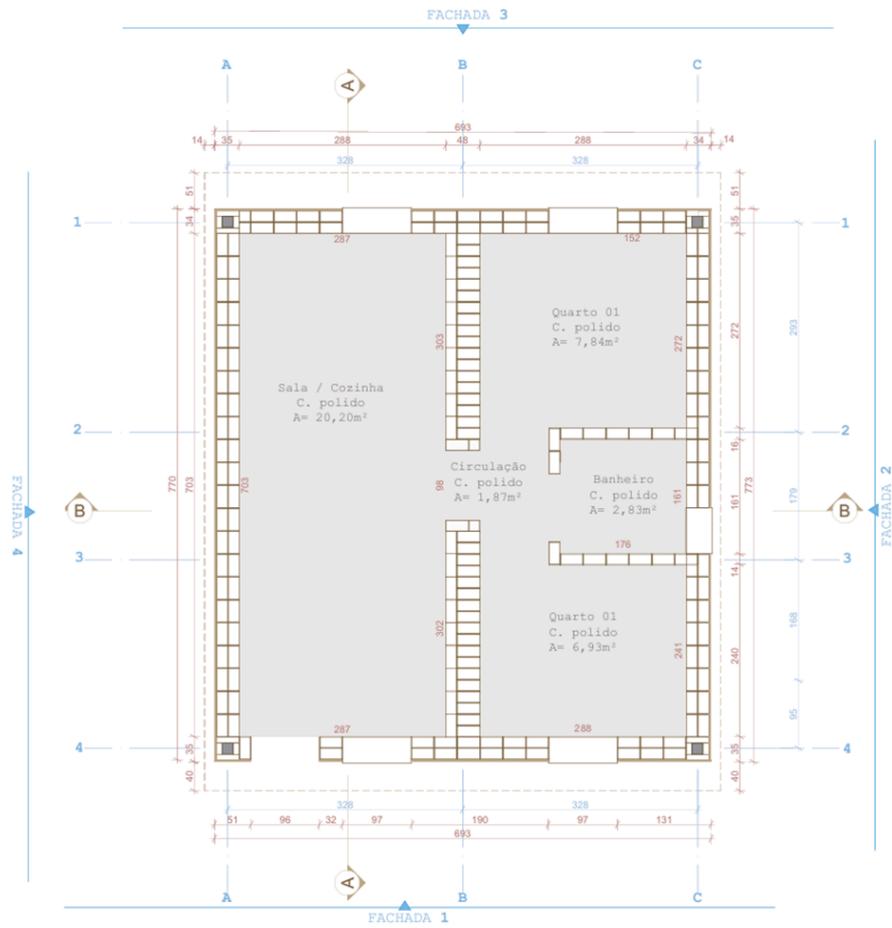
Planta Baixa Fonte: Elaborado pelo autor
